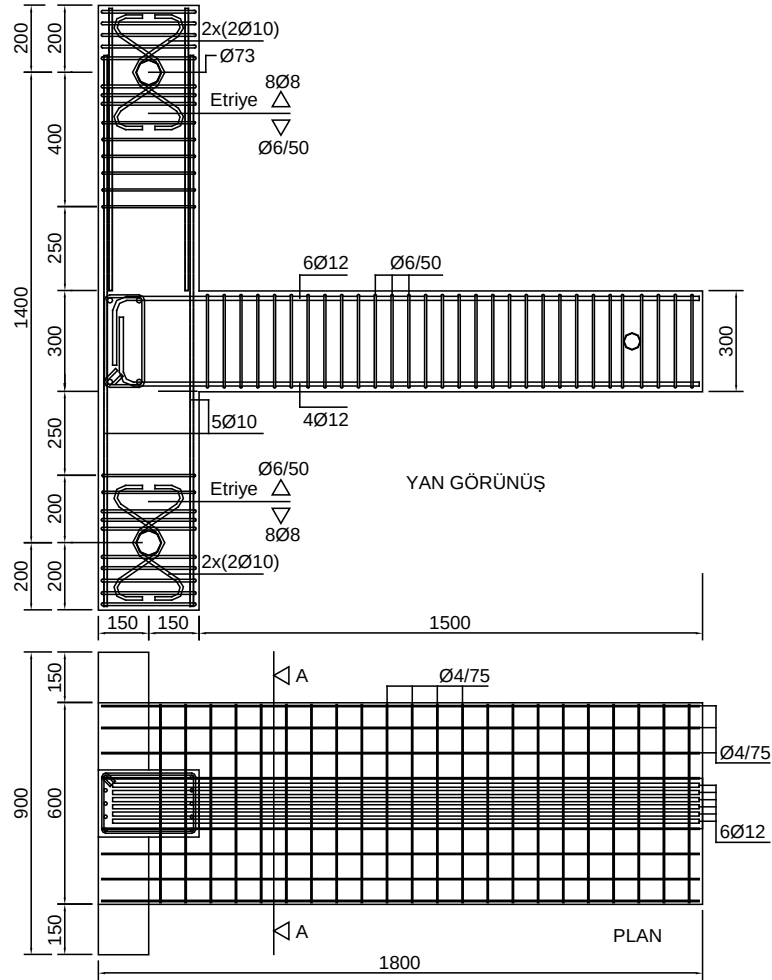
WJ1 elemanı donatı detay çizimleri
